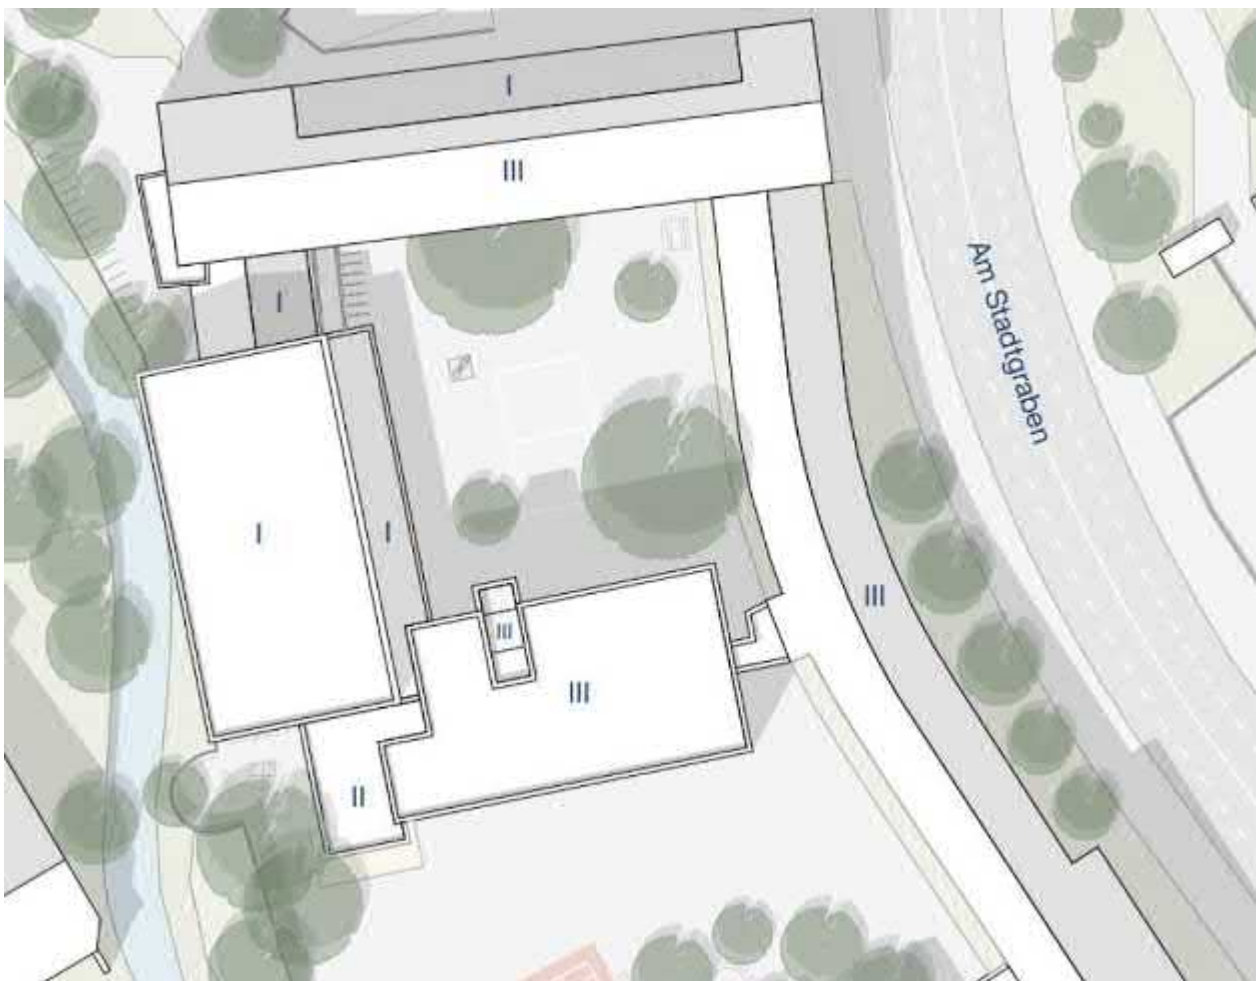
Lageplan Bestand - Stand 06.03.2024 –
